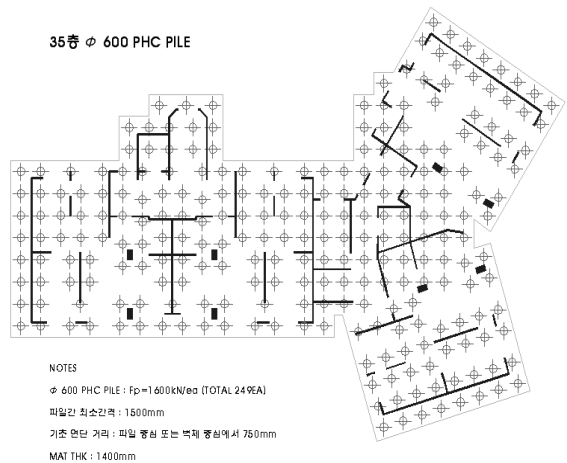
35층 공동주택 모델 평면도 및 말뚝배치도(PHC 600)
